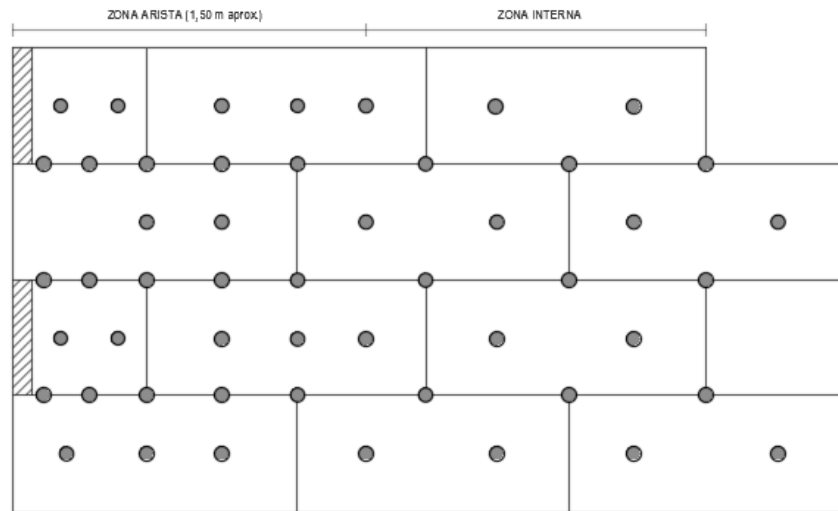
Fijación mecánica de las placas aislantes.
